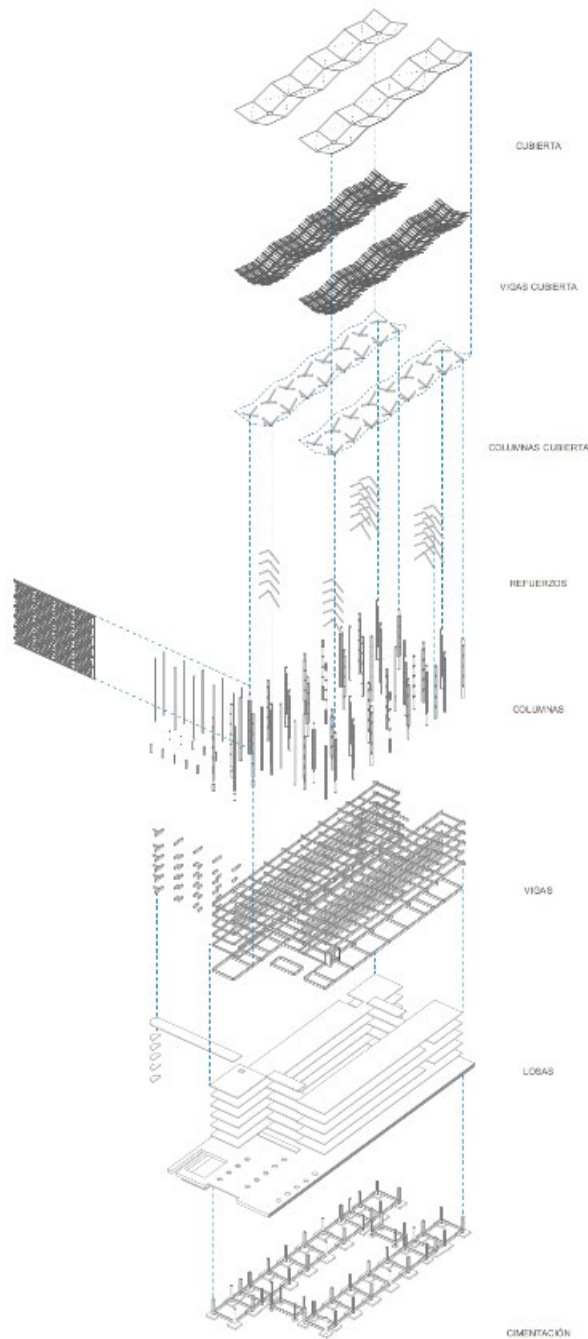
Despiece estructural (elaborado por Lillo D. 2020)
